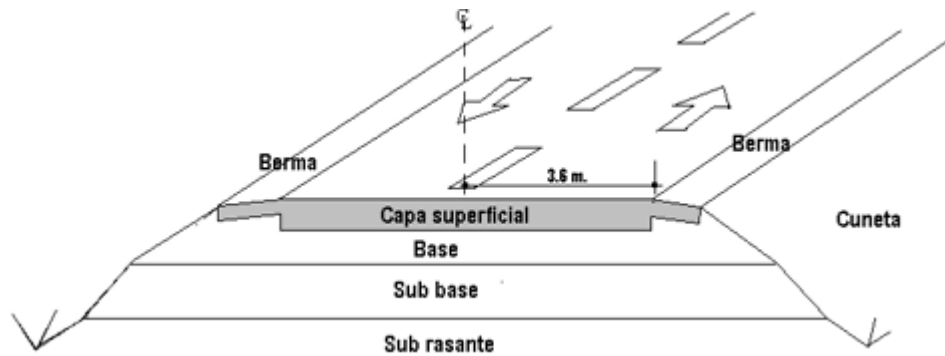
Estructura típica de un pavimento asfáltico (flexible)
